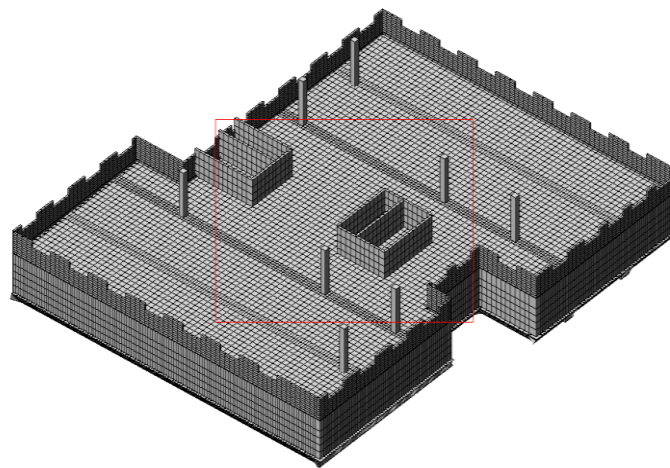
Схема этажа с разрушенными колоннами и стенами монолитного здания
